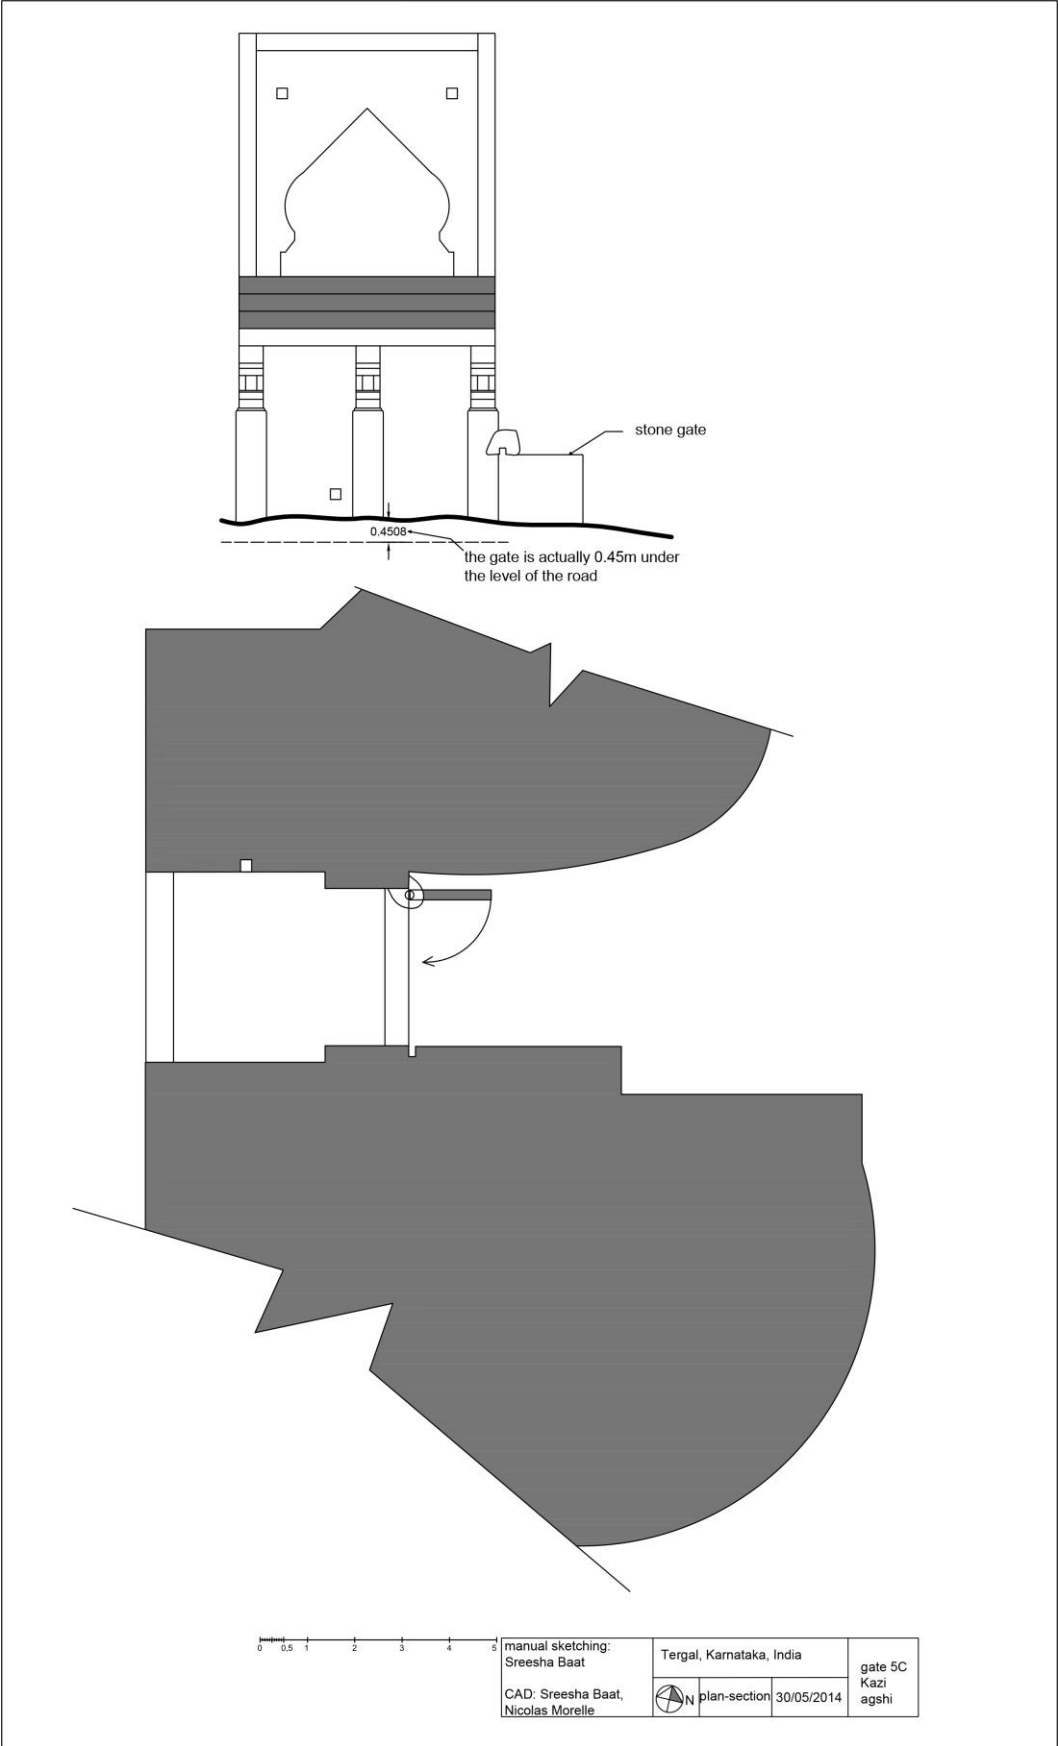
plan et coupe de la porte Kazi Agshi (5c)
